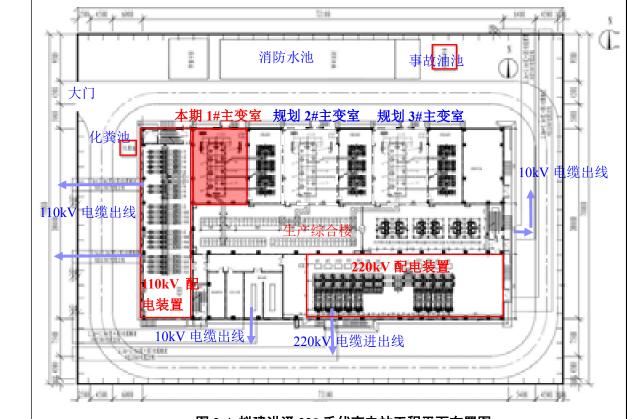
拟建洪泽 220 千伏变电站工程平面布置图
